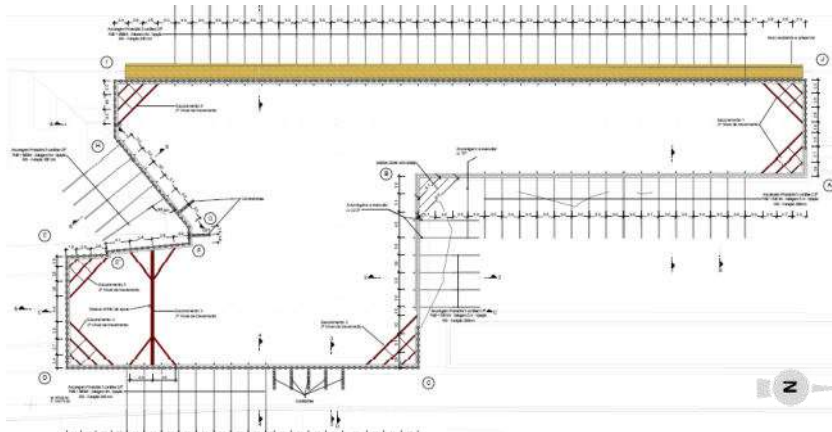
Planta de Dimensionamento da Solução de Cortina de Estacas Espaçada.
